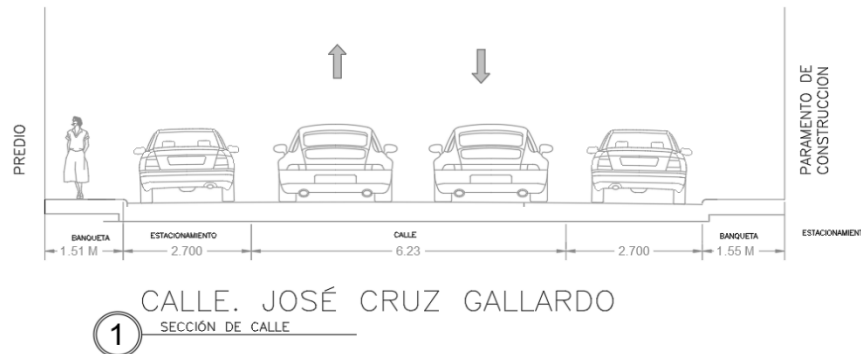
Sección vial propuesta para calle José Cruz Gallardo. Fuente Elaboración propia.
